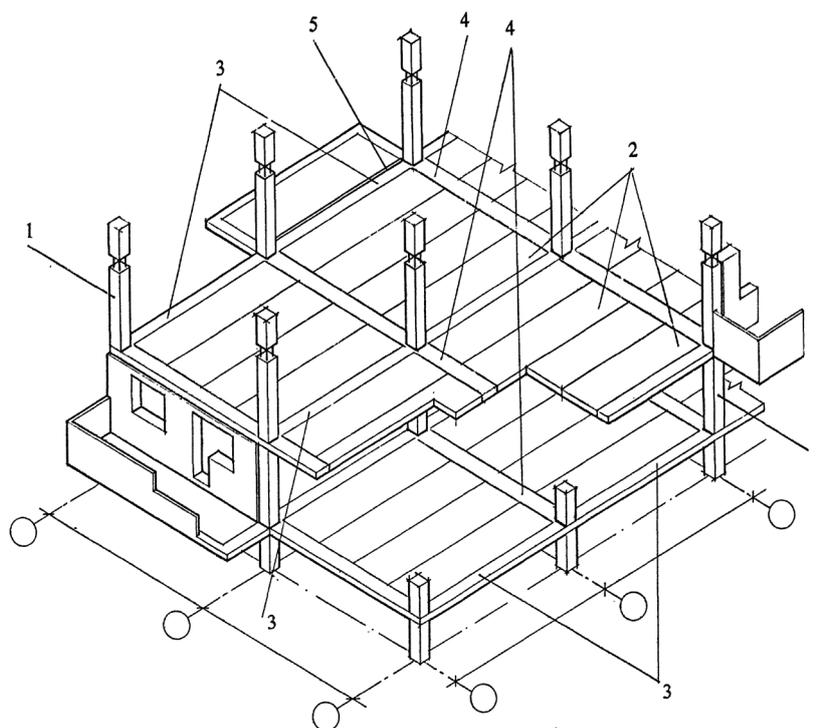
Система на основе каркаса 1–020: 1 — колонны; 2 — многоярусные плиты; 3 — несущие монолитные железобетонные ригели; 4 — связевые монолитные железобетонные ригели; 5 — тепоризолирующая прокладка
